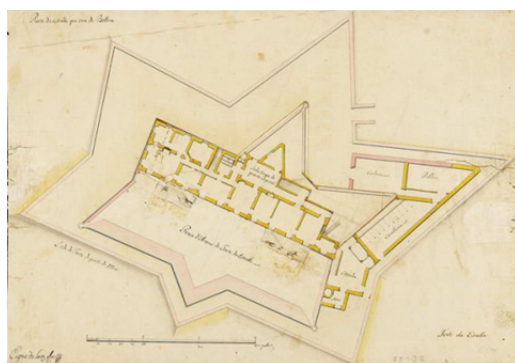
Planta do Forte da Estrela (Cota: GEAEM 782-1 -5-9, 1856)
